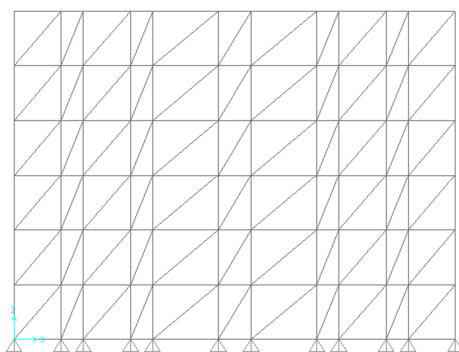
Configuração dos Planos de Contraventamento Vertical Com Elementos de Contraventamento Pequenos
